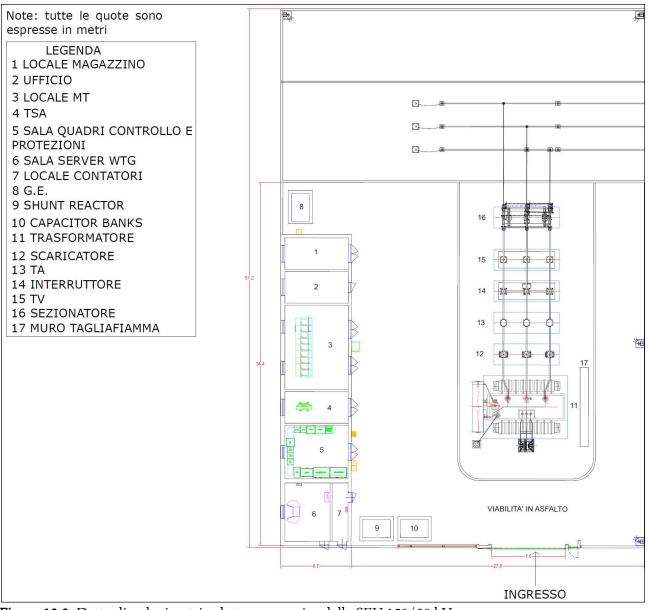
Dettaglio planimetria elettromeccanica della SEU 150/30 kV
